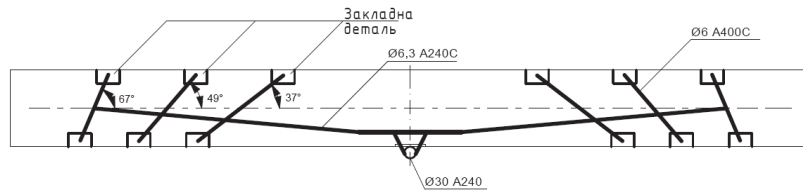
Схема підсилення балки БПС-II-1 поздовжньою і поперечною похило розташованою зовнішньою арматурою
